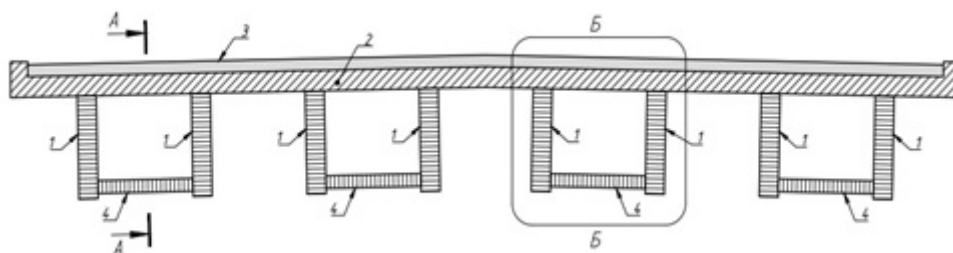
Деревобетонное пролетное строение с балками из клееной древесины заводского изготовления.
